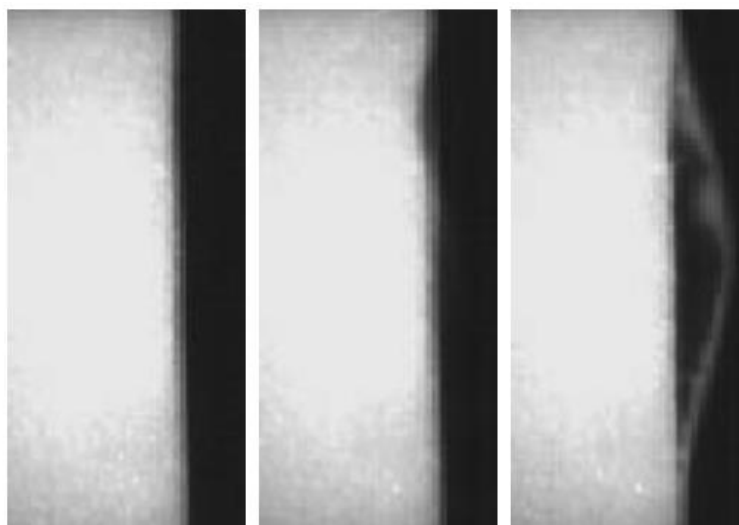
images d’un flambement local sur poutre sandwich prise par (Rivallant, 2003) à 0,5 ms d’intervalle.
